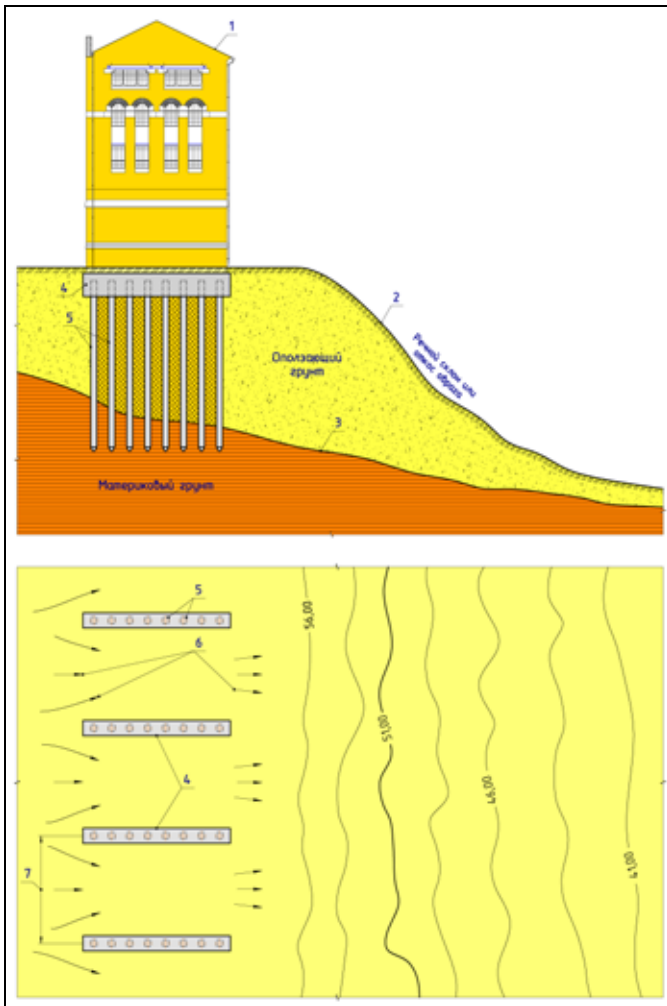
Схема, поясняющая применение противооползневой конструкции в виде поперечных конструкций-диафрагм: 1 – здание или сооружение, возводимое на склоновых территориях; 2 – речной склон или откос оврага; 3 – поверхность сдвига; 4 – конструкция-диафрагма, состоящая из прямолинейного расположения призматических свай 5; 6 – потоки грунтовых вод; 7 – шаг диафрагм (может составлять 4,5–6,0 м)
